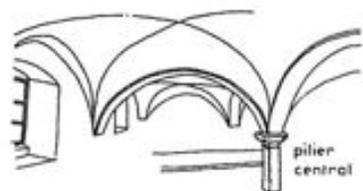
DETAILS ARCHITECTURAUX EN TARENTEISE - Croquis de principe
